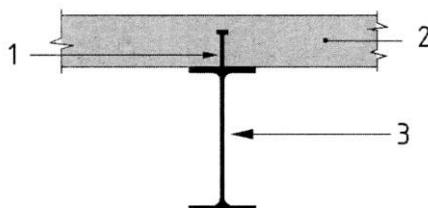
Сечение сталежелезобетонной балки: 1 - анкерный упор; 2 - железобетонная плита; 3 - стальной профиль
